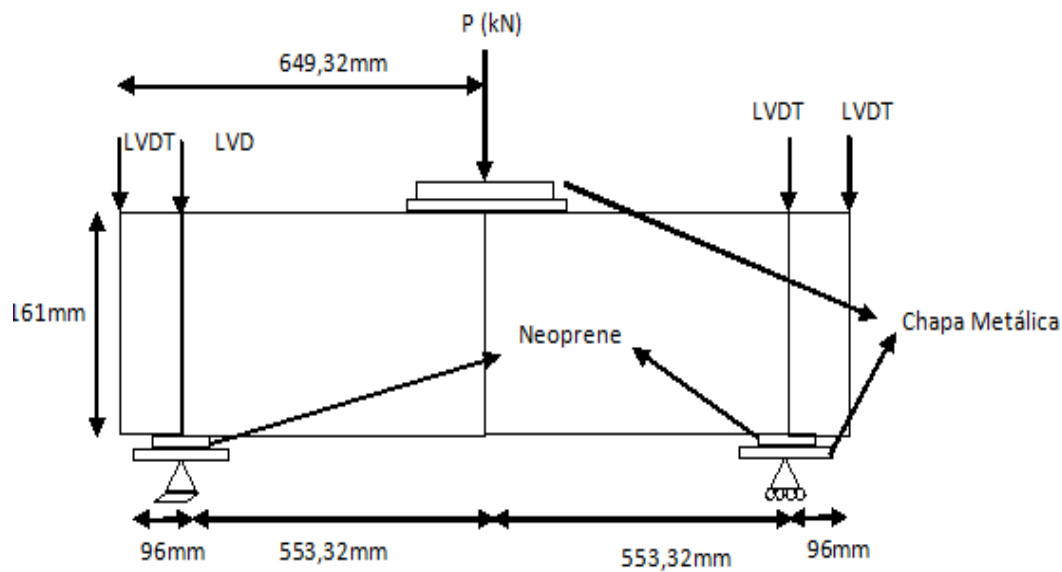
Dimensões da montagem do ensaio e ubiquação da instrumentação no dormente D.P.2.0.E.F.1.C.5.
